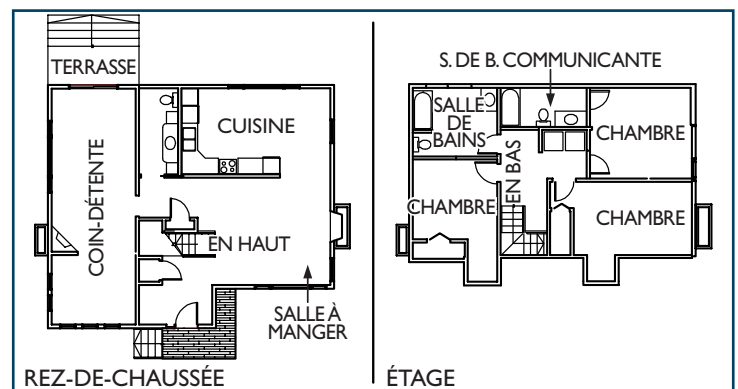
Plans de la maison existante avant les rénovations pour la rendre accessible
